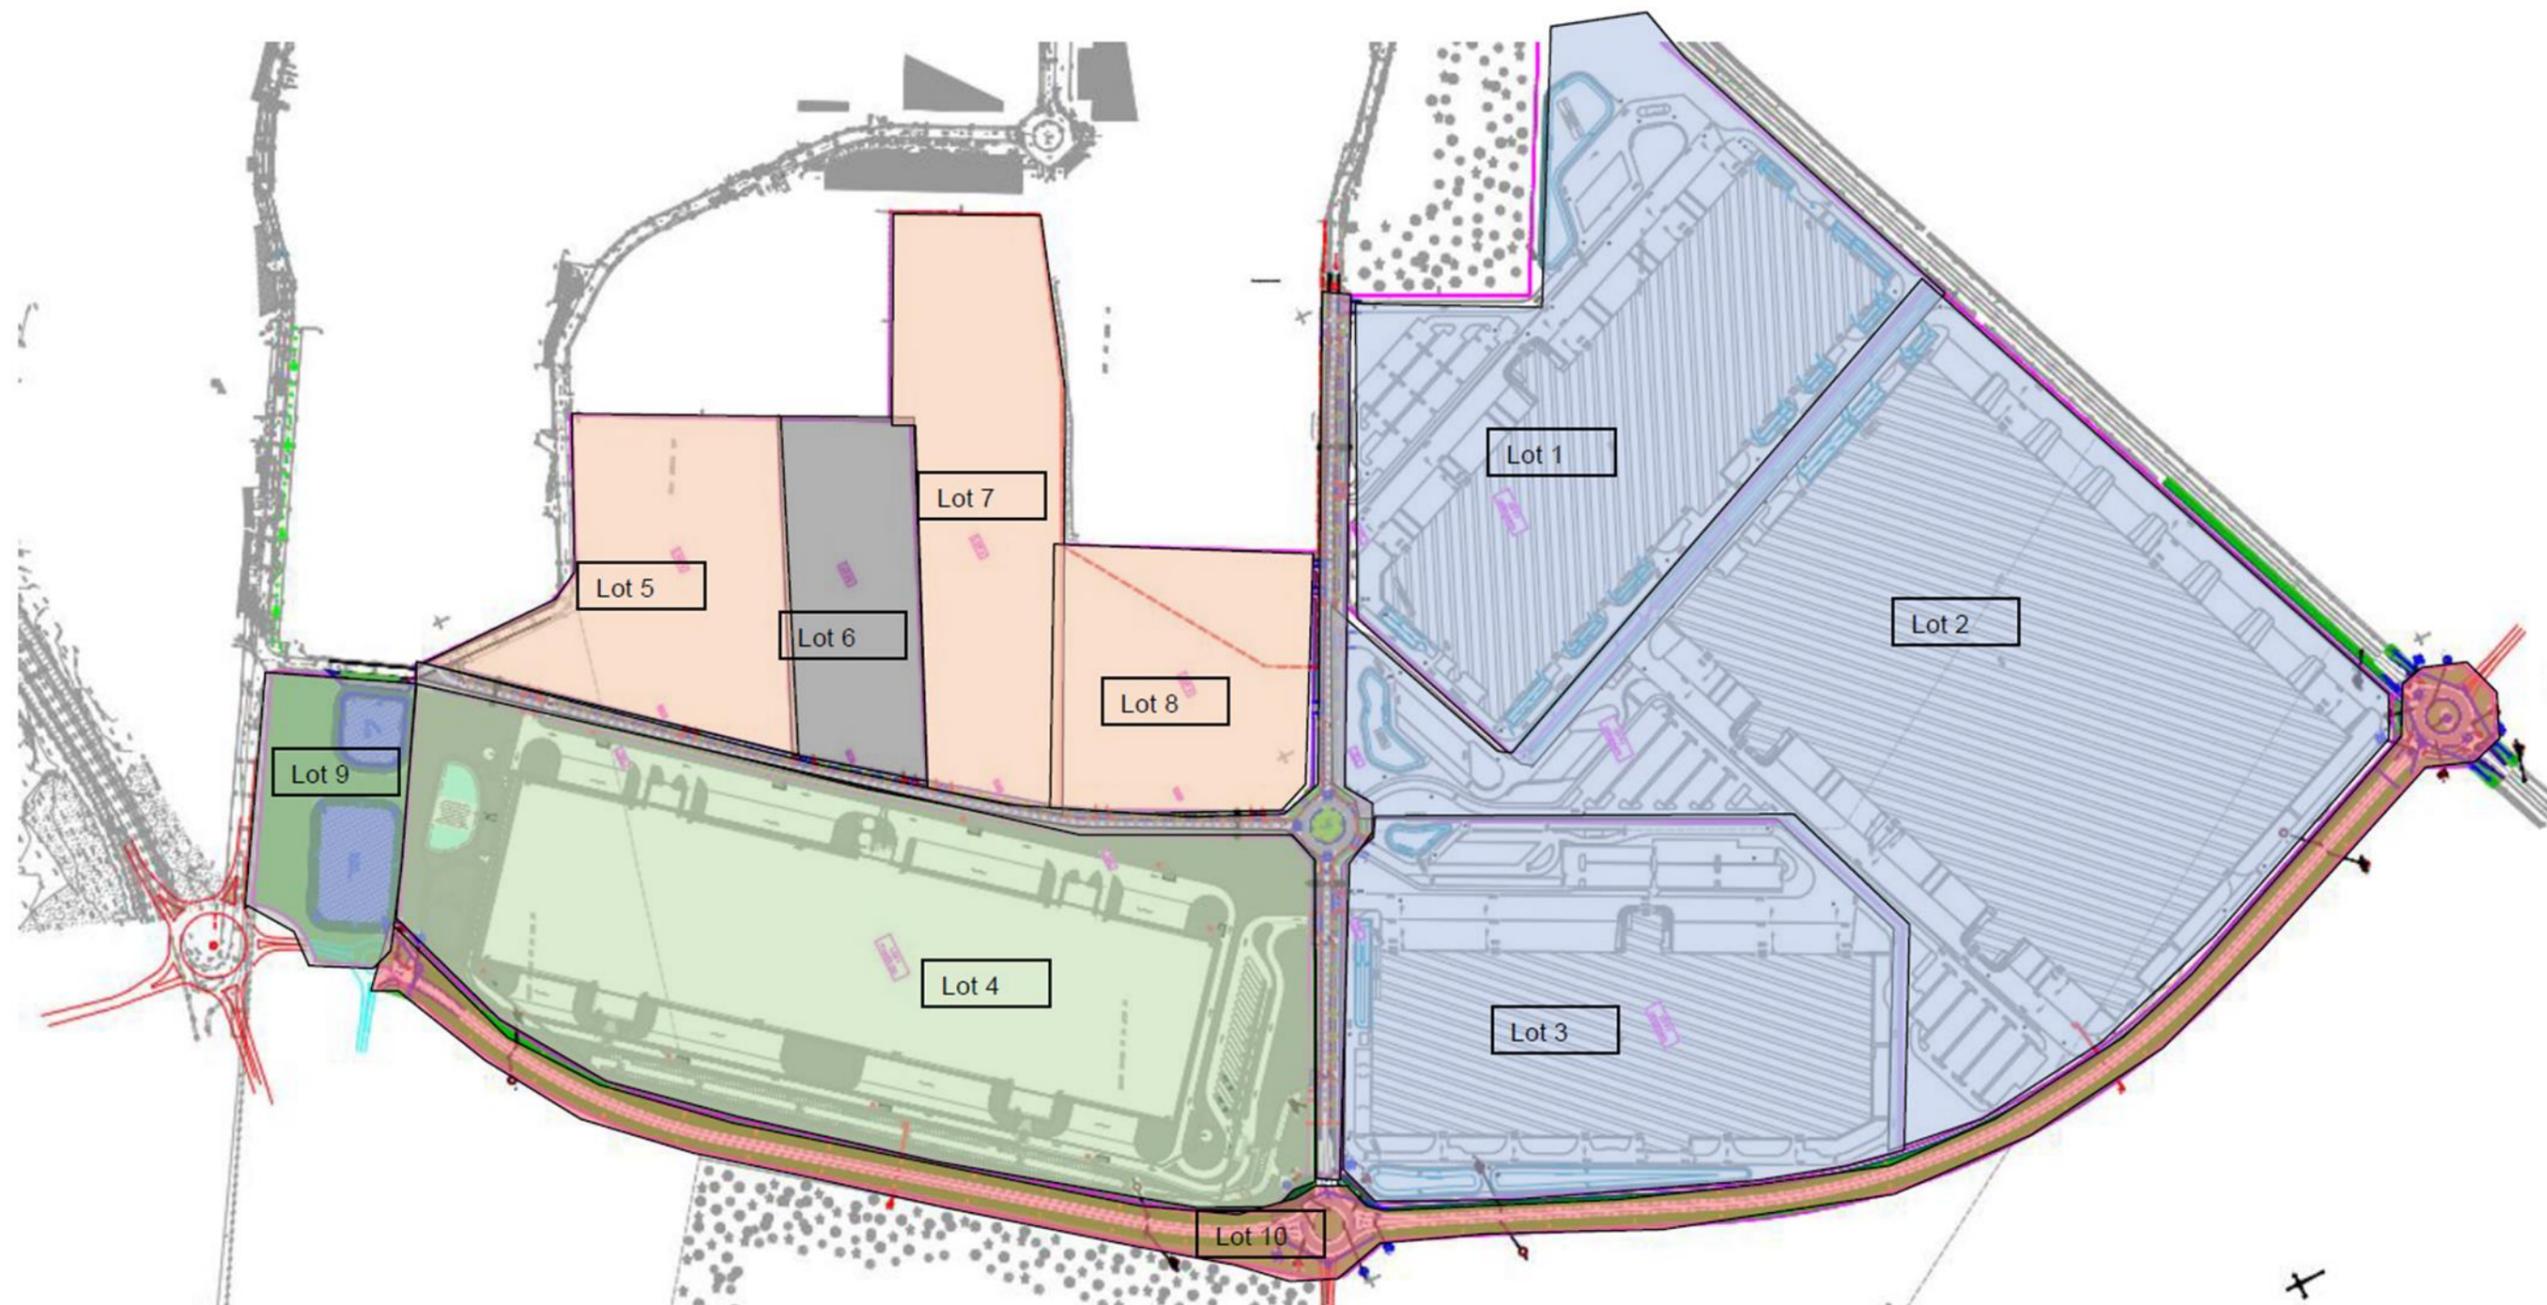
PLAN D'ILOTAGE DE LA ZAC
